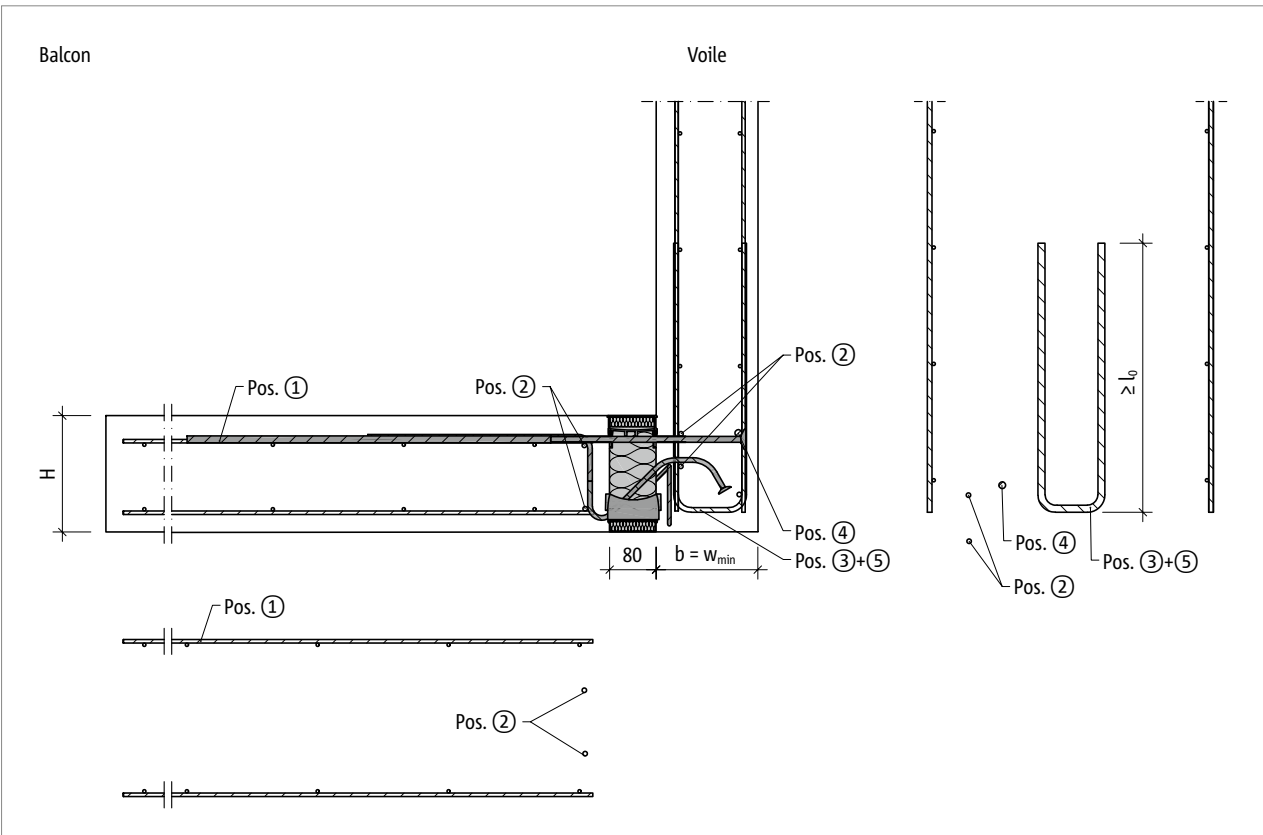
Schöck Isokorb® T type K-U : Renforcement sur site pour raccordement mural avec une dimension minimale du composant ($w_{pres} = w_{min}$)
